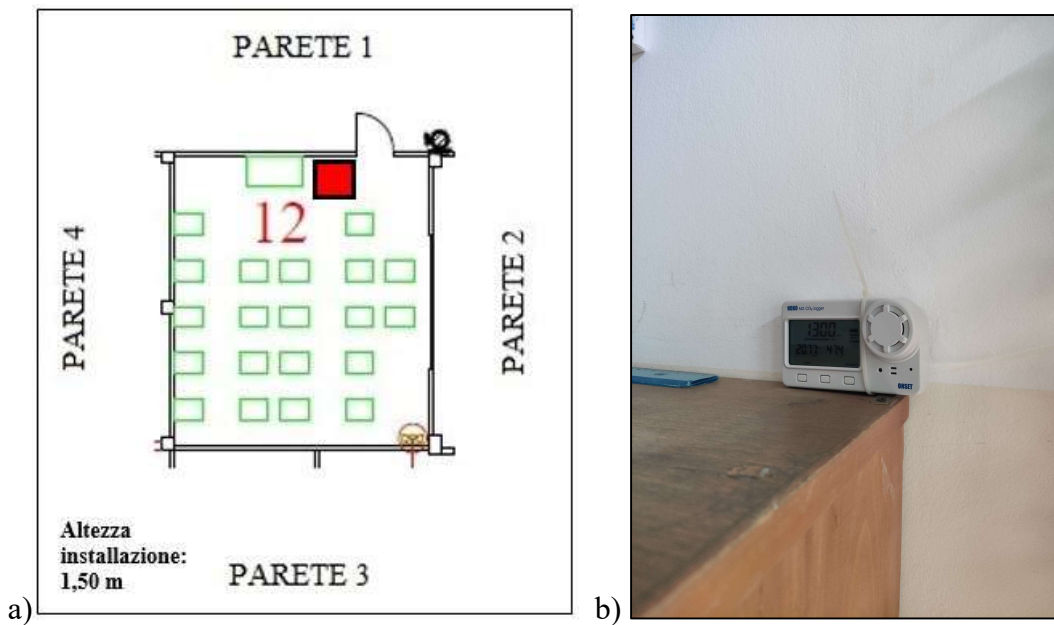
Posizione acquisitore in pianta (a) e in foto (b) Aula 12 (5^a)
